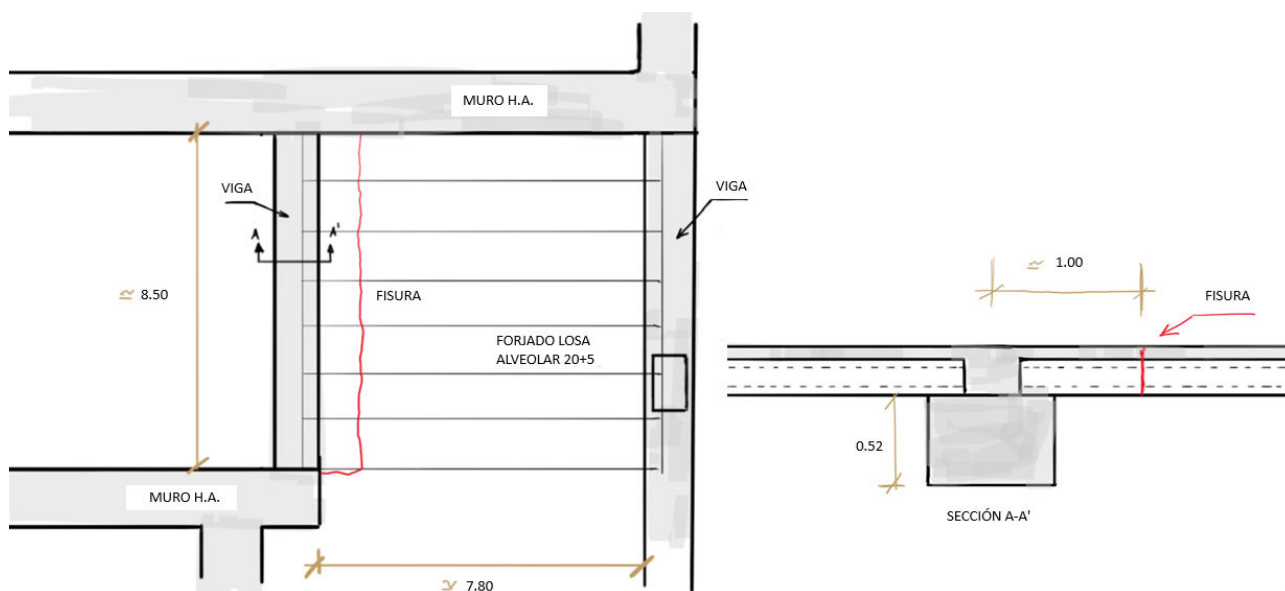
Planta de detalle de localización de la fisura (izda) y sección por la viga de apoyo del forjado alveolar (dcha.)
